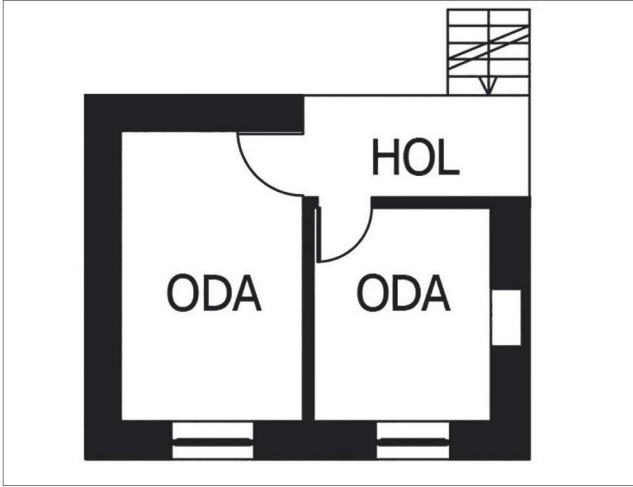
873 Parsel, 1. Kat Planı / Building lot: 873, first floor plan
